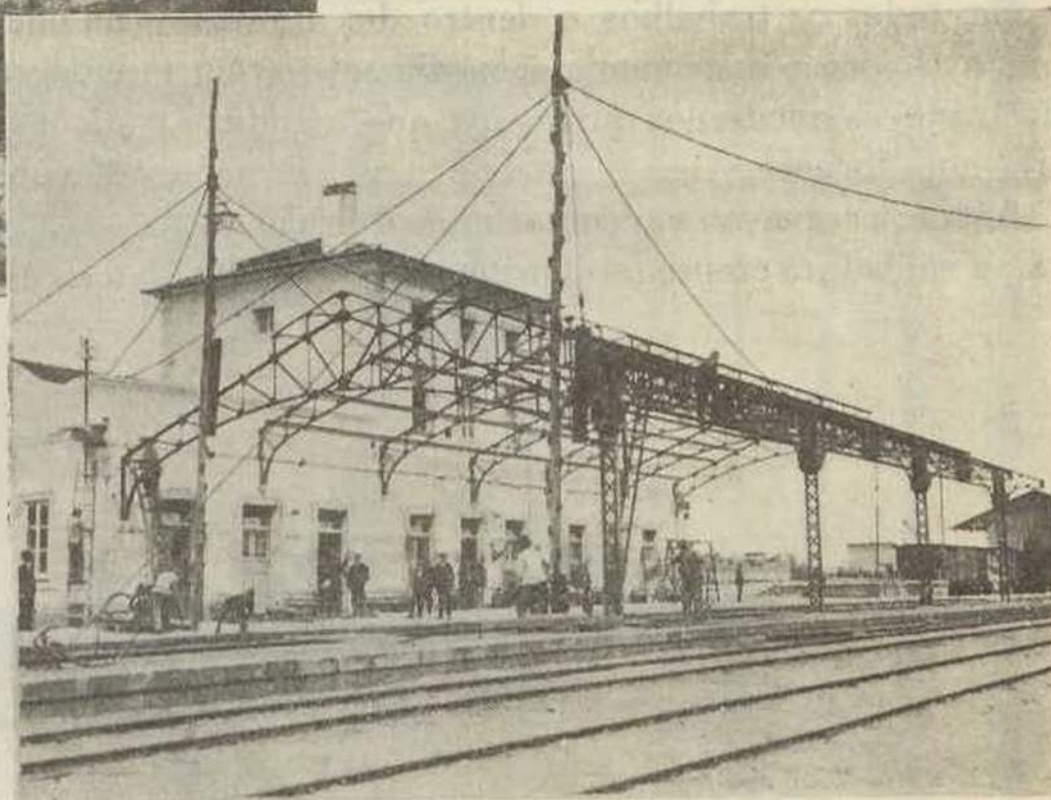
Construção de um alpendre metálico na estação de Ovar
